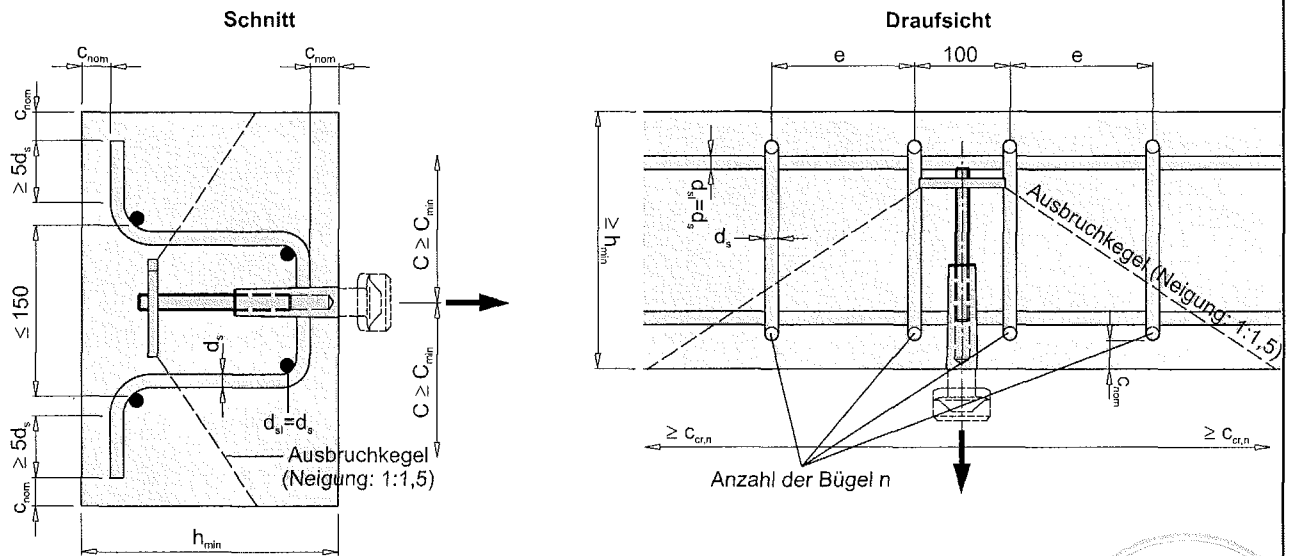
Einbausituation in dünne Wände - Zugbeanspruchung mit Rückhängebewehrung - Bewehrungslage
